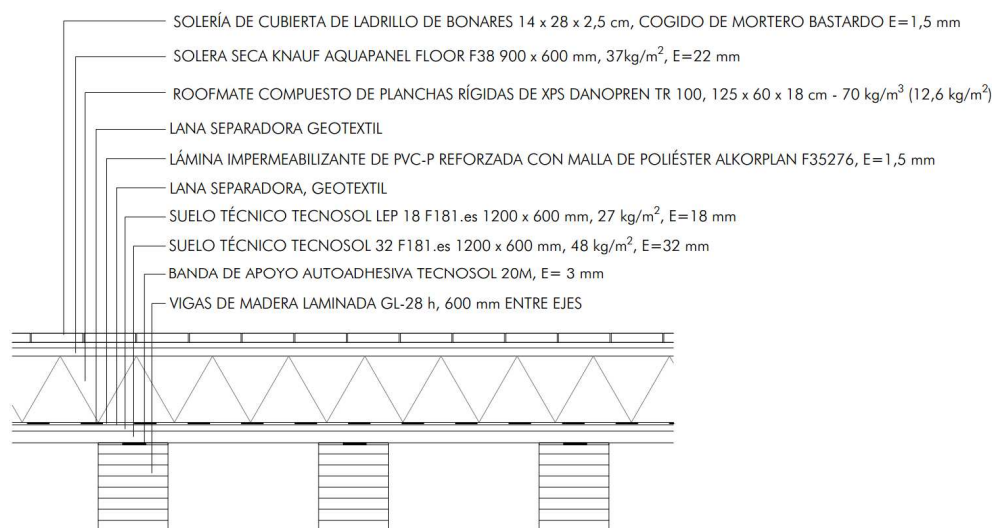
Sección constructiva de faldón de cubierta plana
